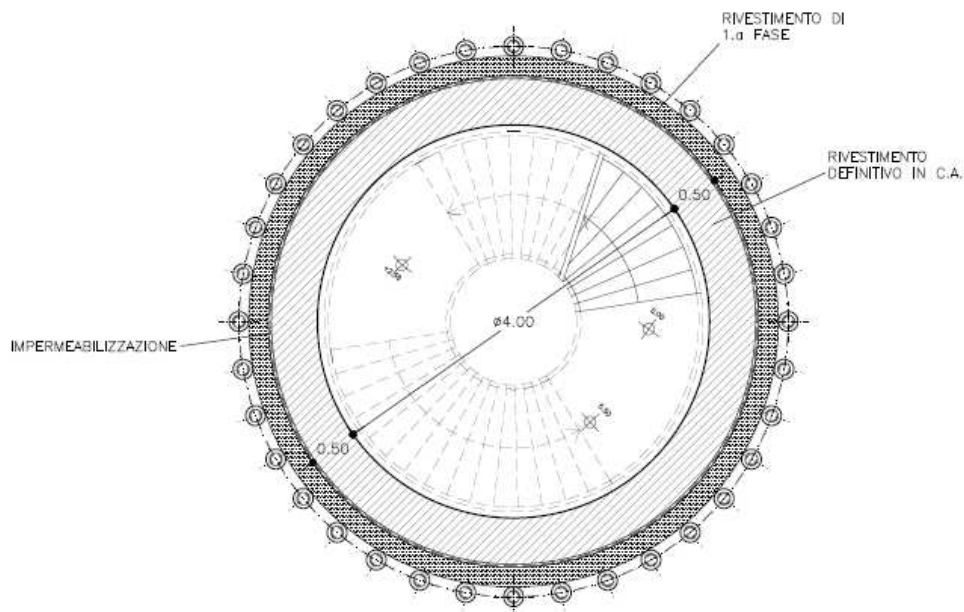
Pozzo di accesso alla cabina TE: sezione in pianta 2 di 2
